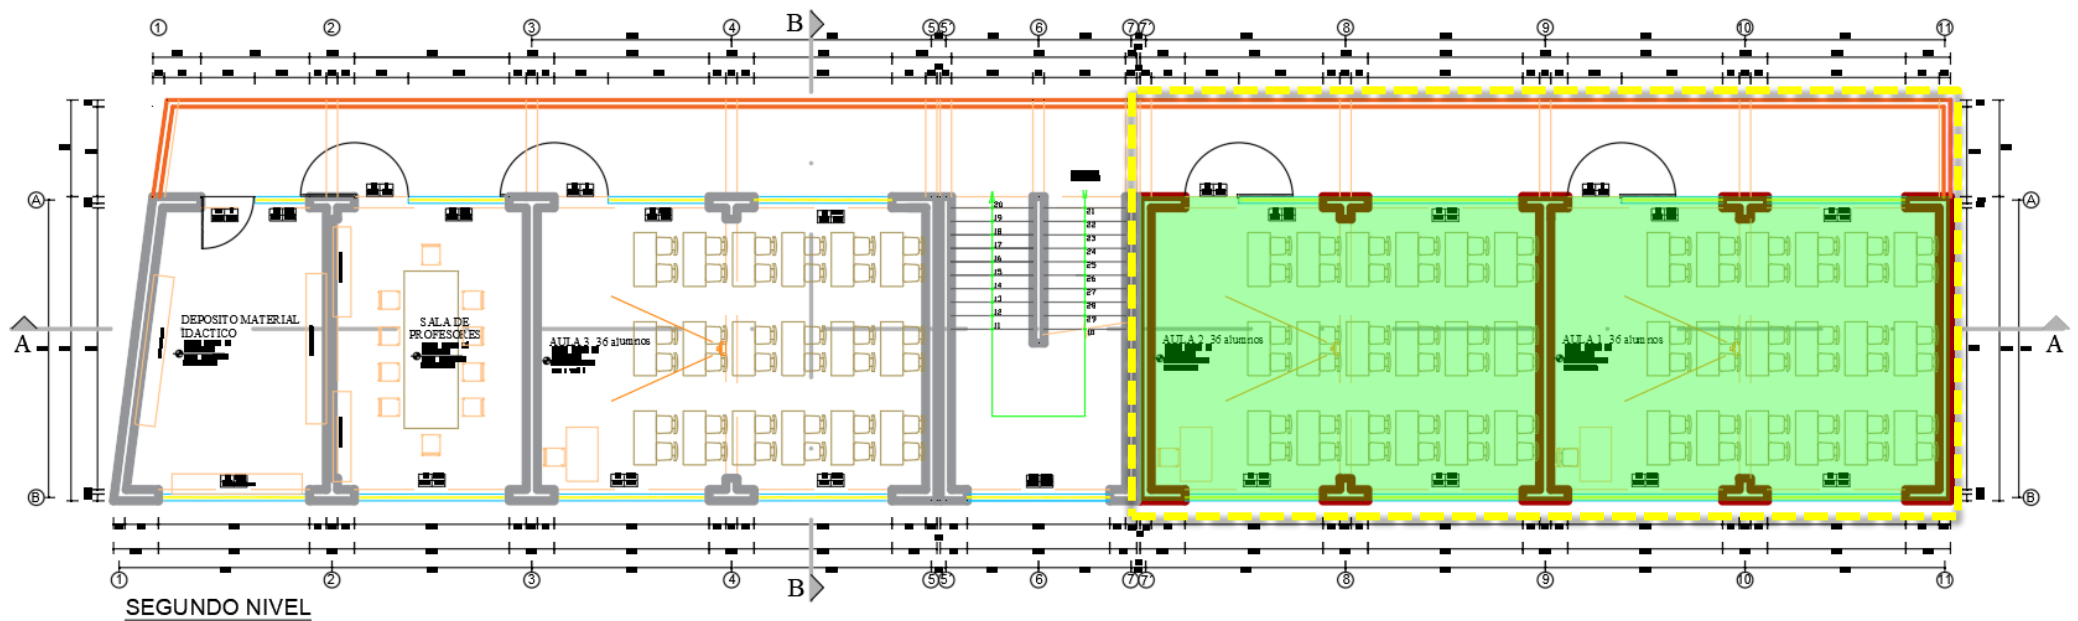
Vista en planta, piso 2, bloque 2 del pabellón A - I.E. N°40092
